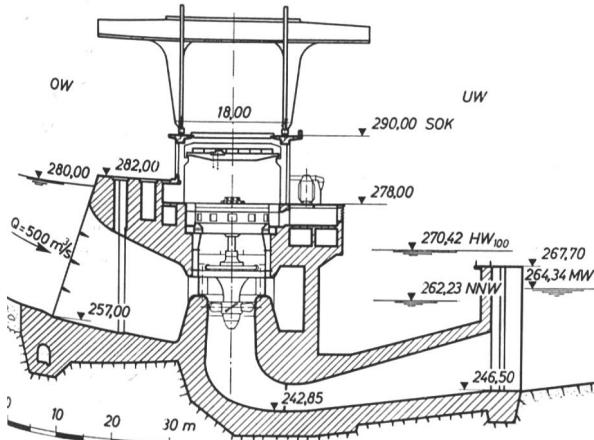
Schnitt durch das Maschinenhaus des Kraftwerk Aschach
